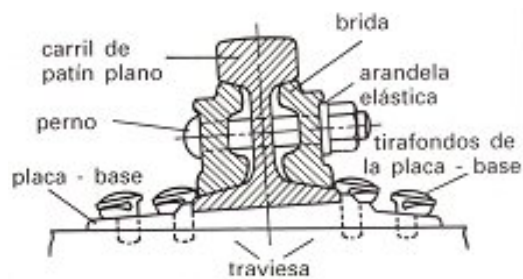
2: Sección transversal de la junta entre los tramos de un carril de patín plano apoyado
